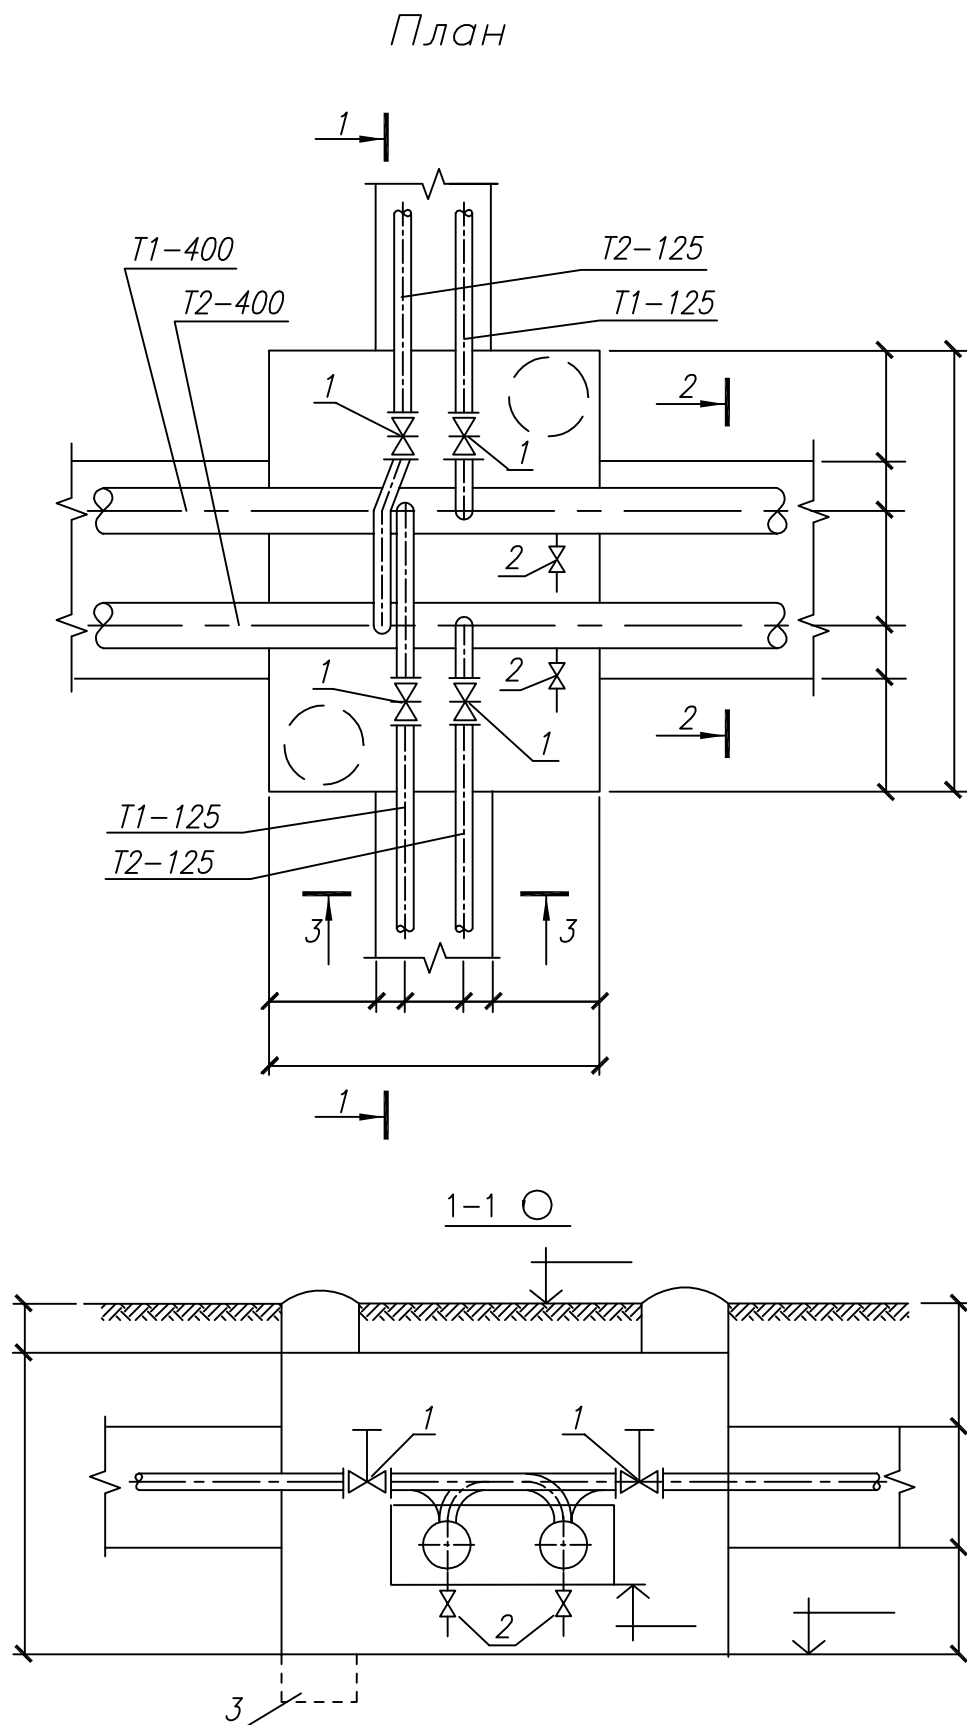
Тепловая камера УТ. План, разрез 1-1
